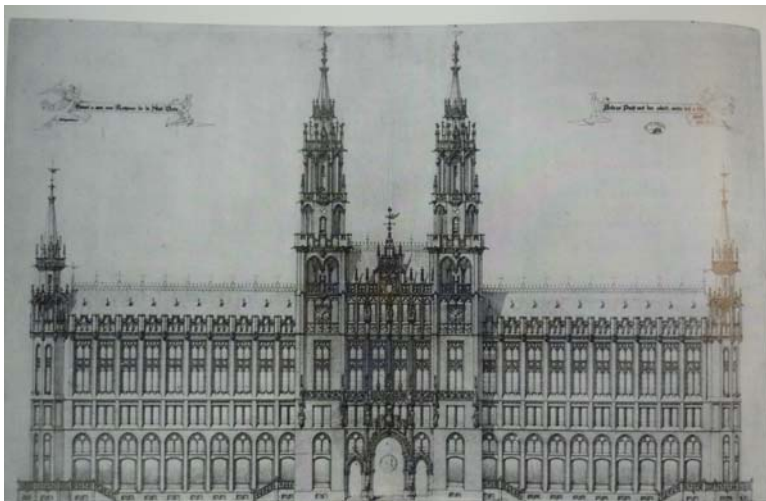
Berliner Rathaus, Fassade mit Detail, 1858
